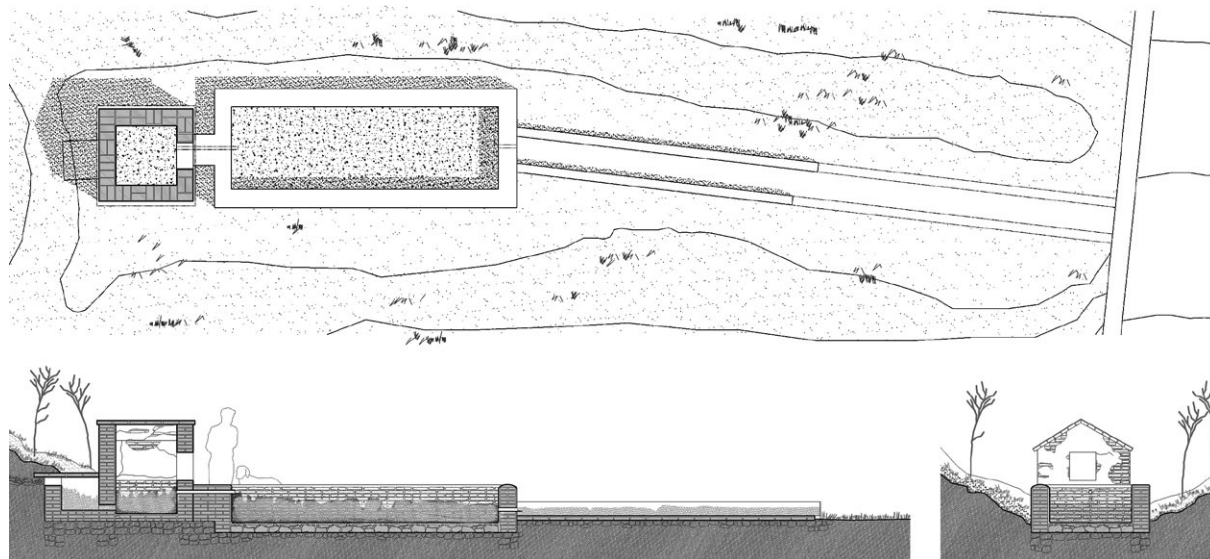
Planta, sección longitudinal y sección transversal de la fuente Nueva.
